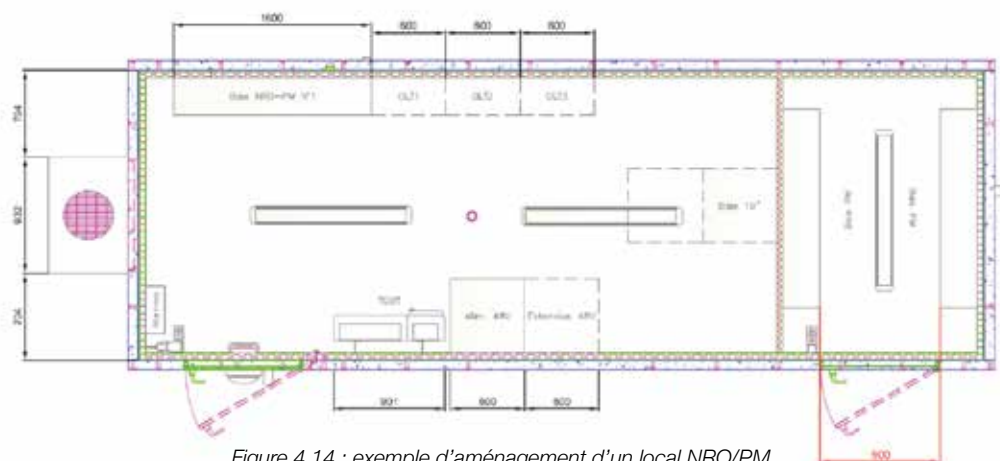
exemple d'aménagement d'un local NRO/PM
